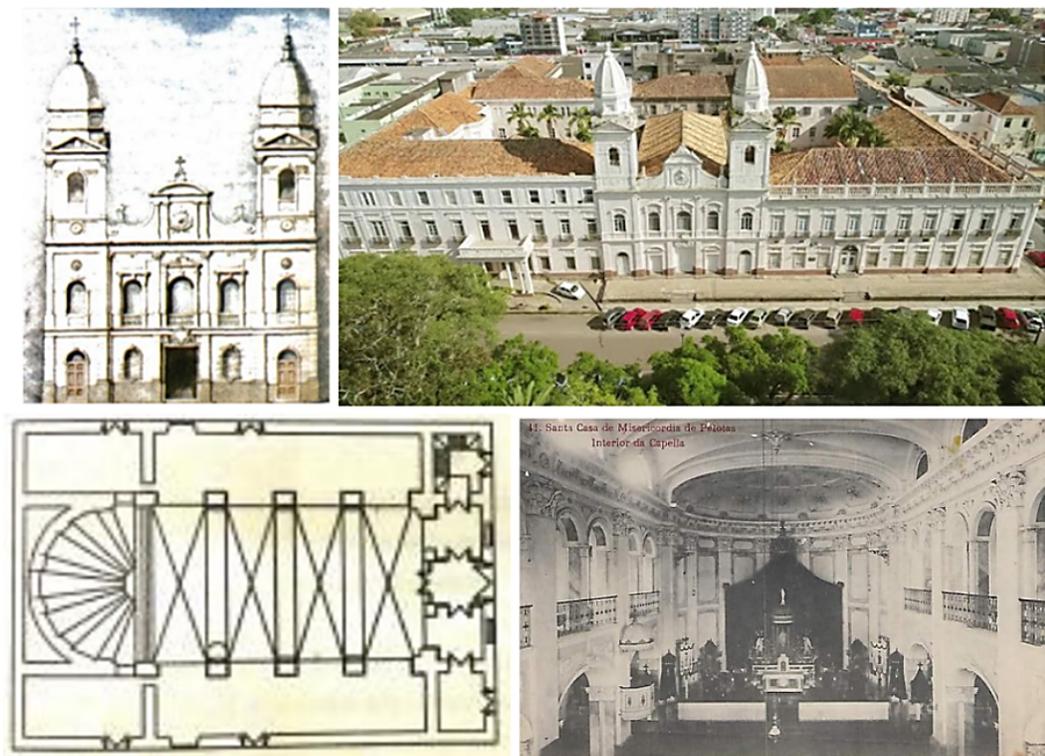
Fachada da Santa Casa de Misericórdia, Desenho da fachada e planta baixa ao centro e meia cúpula vista da entrada da Capela.
